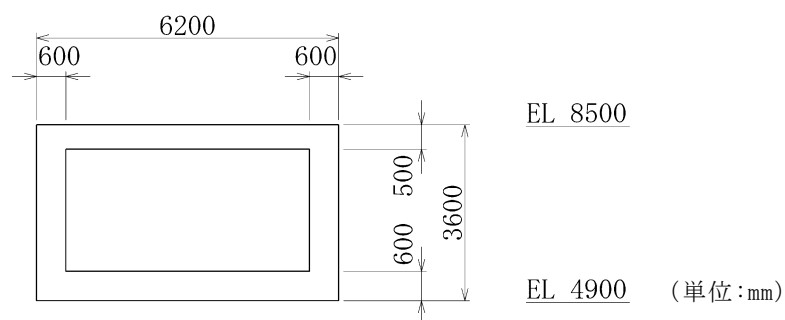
(4) 屋外配管ダクト (タービン建物～排気筒) 断面図 (D-D 断面)
